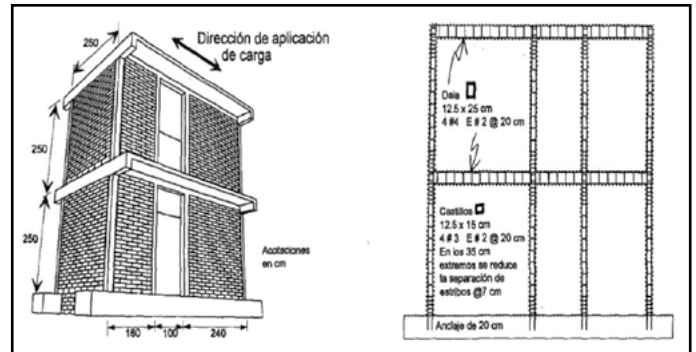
Fachada y alzado de vivienda estudiada (CENAPRED).
